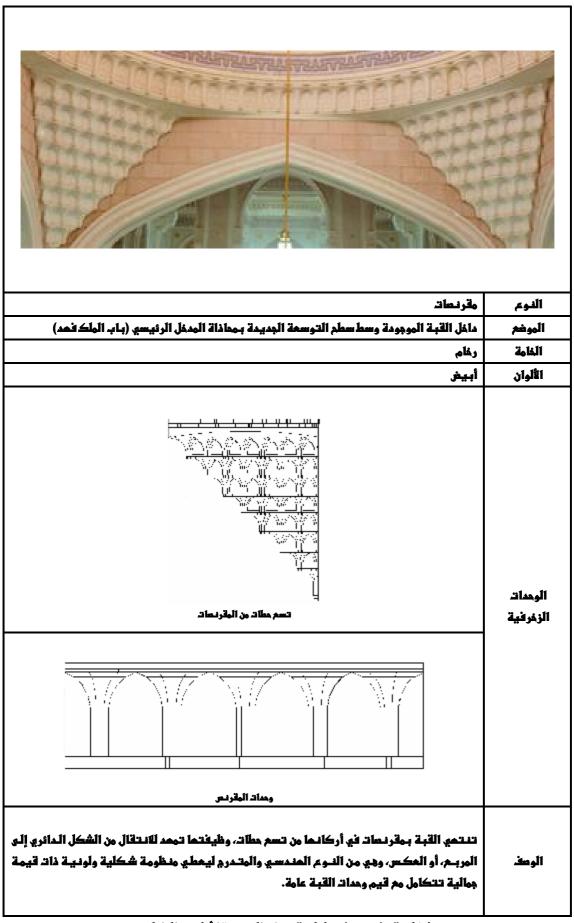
٣٩) تعليل شباك قباب التوسعة الأولى من الداخل
